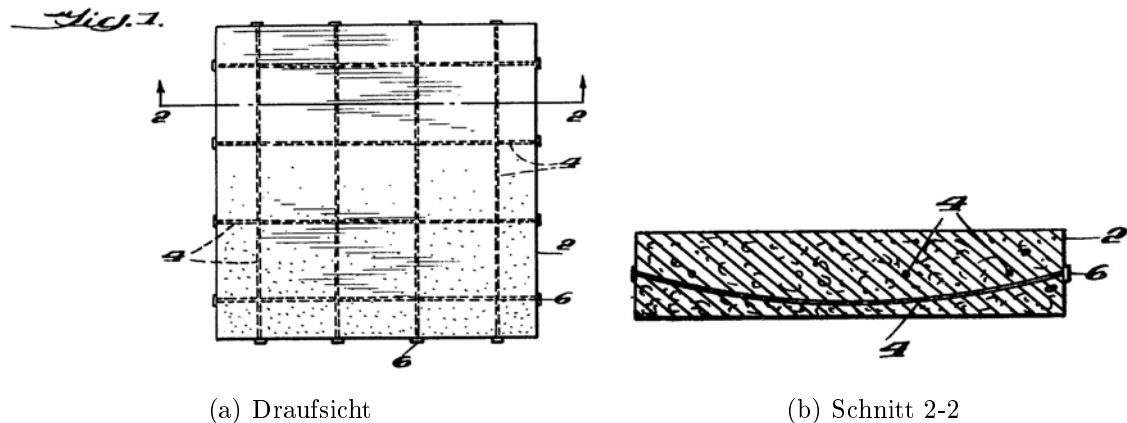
Bauelement aus Beton [Lang, 1971]
